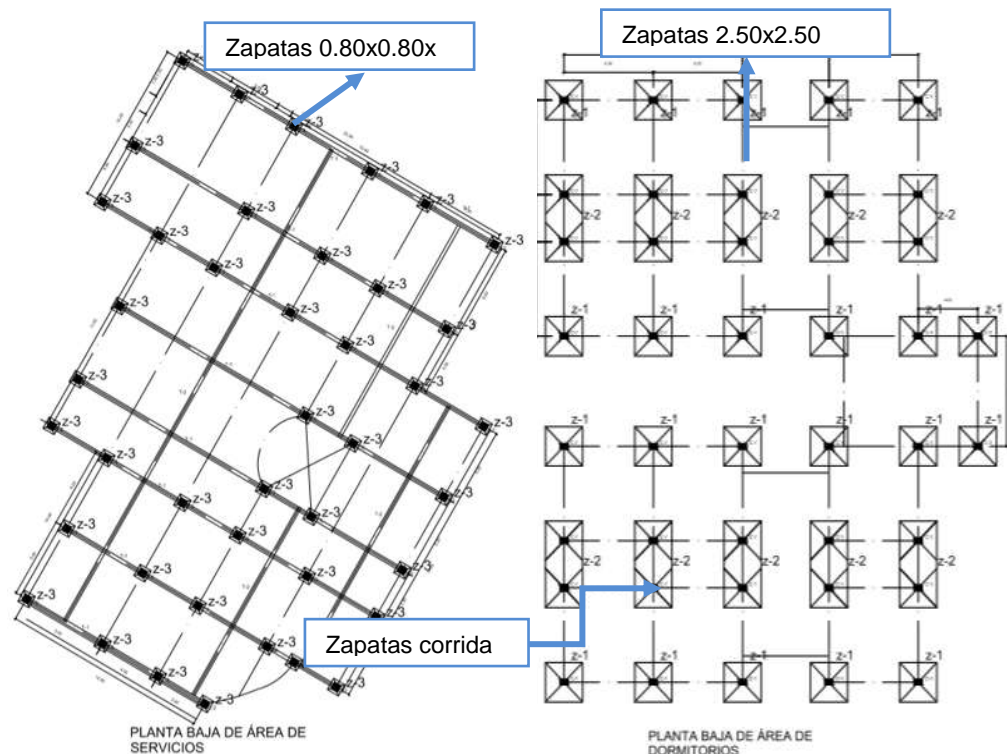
, Planos de cimentación: fuentes: planos del autor.
